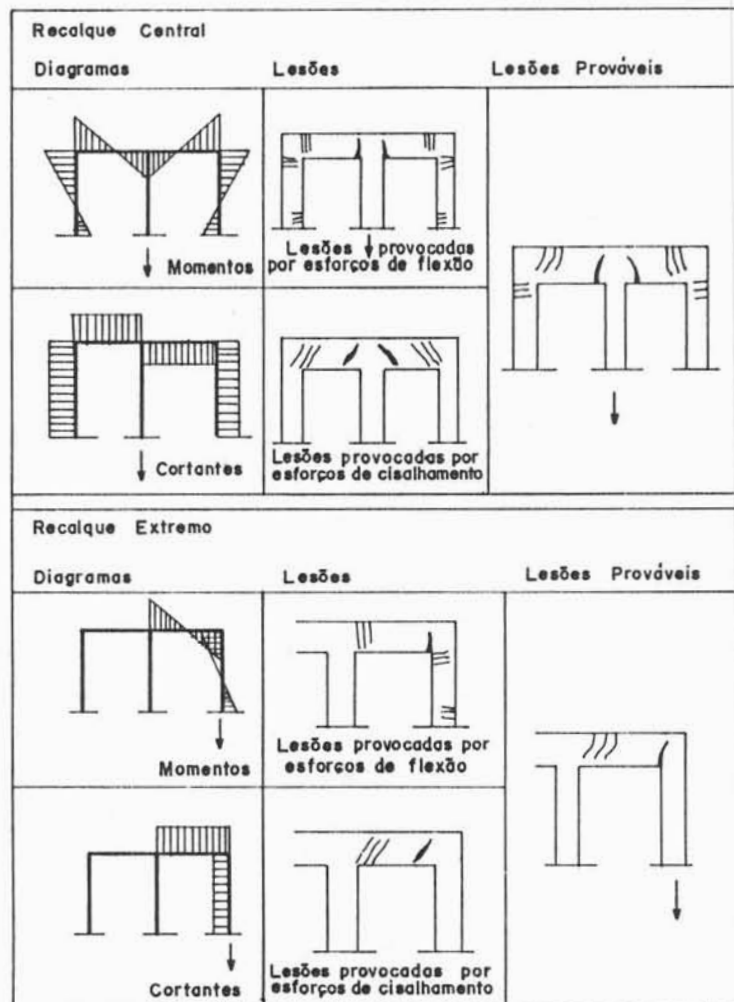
Recalques em estruturas de concreto armado em pórtico.
